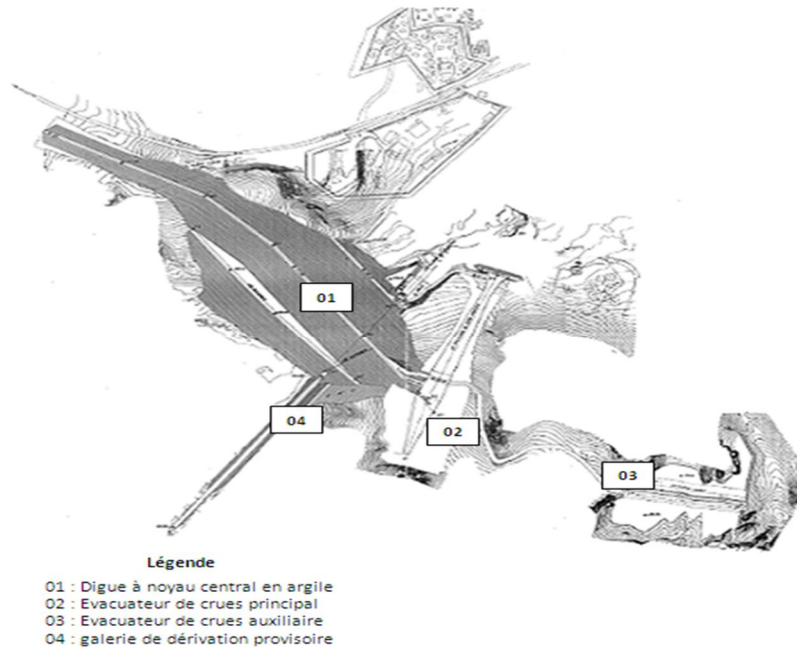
Vue en plan des ouvrages du barrage Boughrara (Tractebel, 2000b)
